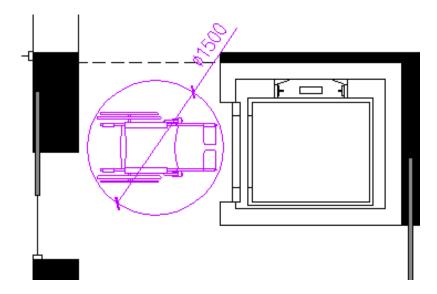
Detalle de la accesibilidad al ascensor en la planta baja.
